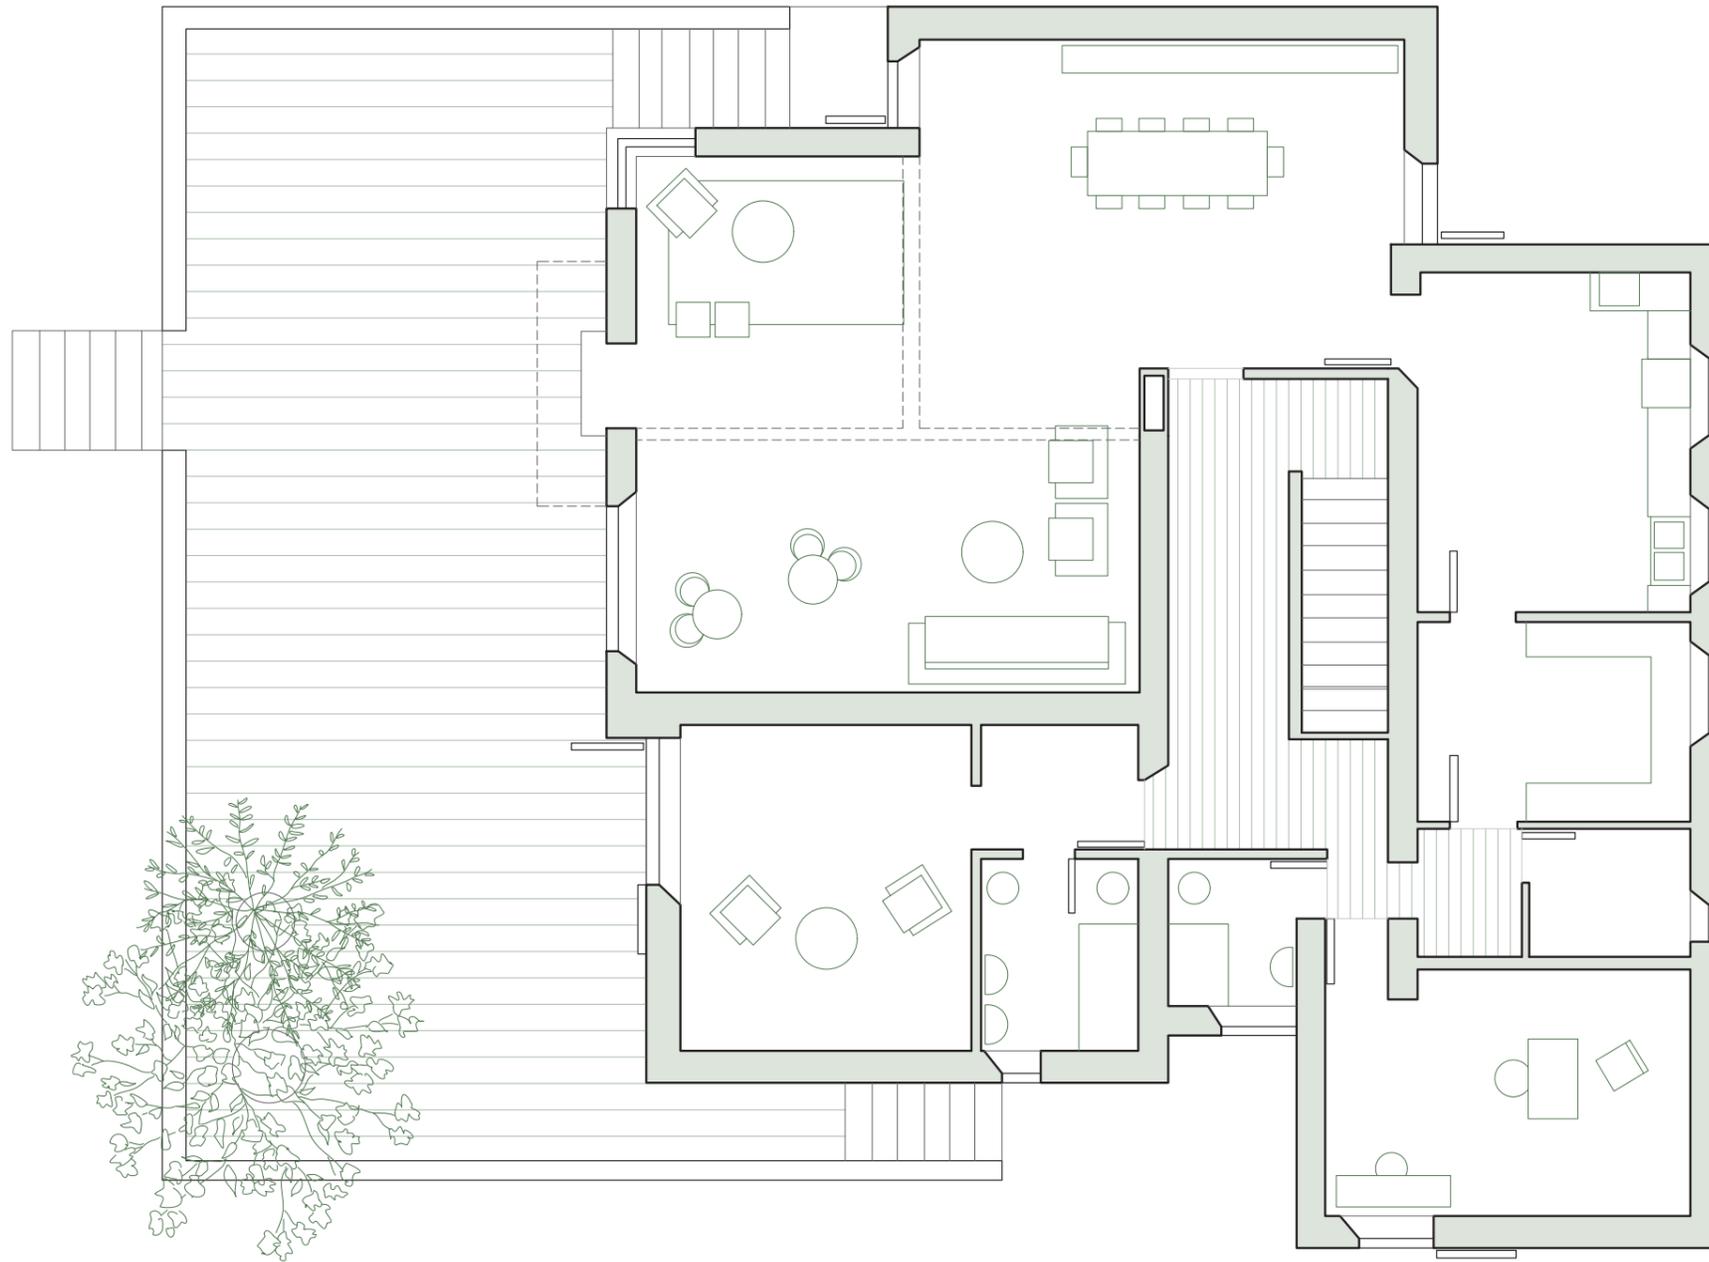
Planta baja, Casa López Huici. Escala 1:100
